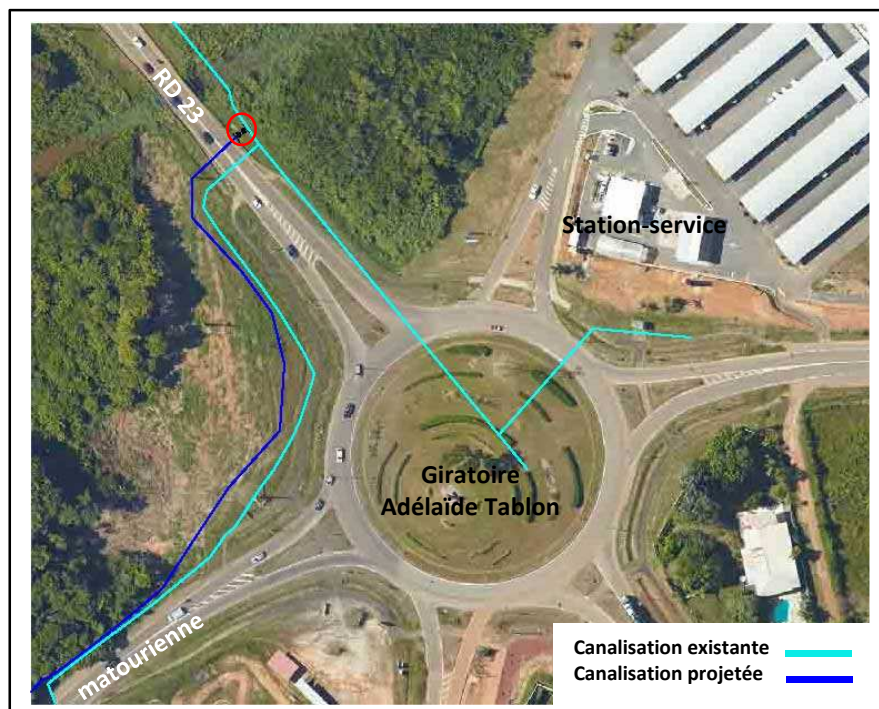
Raccord en attente sur la RD 23 en traversée de chaussée
